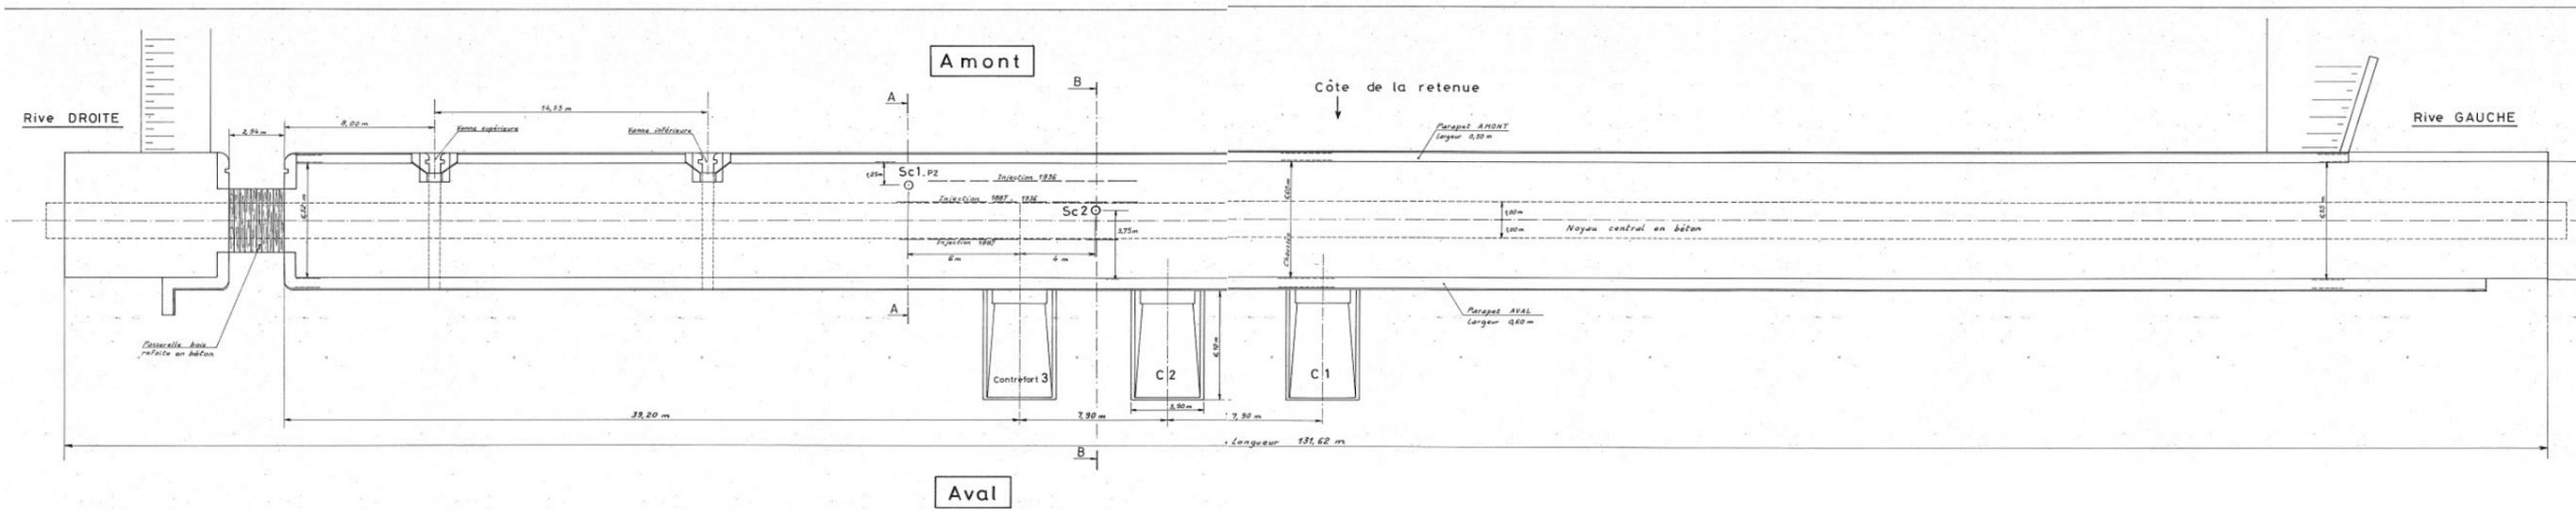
Vue en plan de l'ouvrage avec localisation des coupes type (source CETE 1987)
